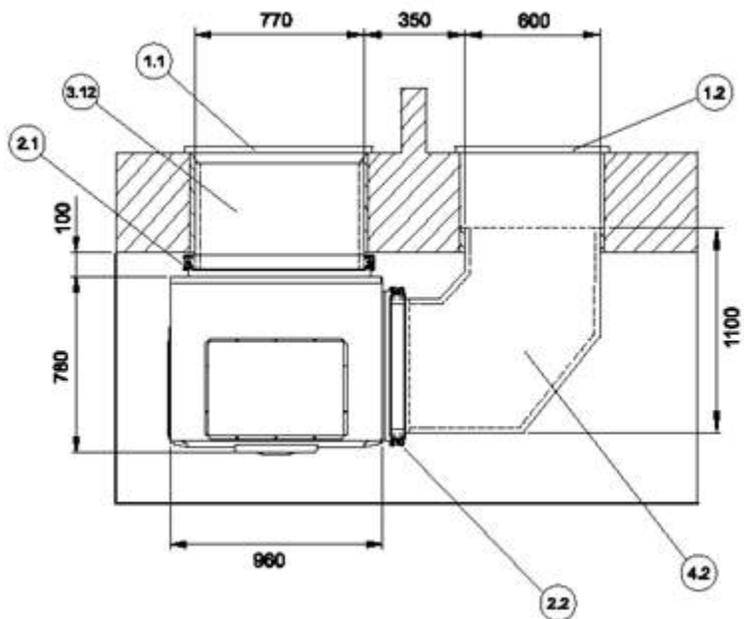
Vista dall'alto - LI 9TU, LI 12TU e LI 16I-TUR (installazione a parete con canale aria lato mandata)
